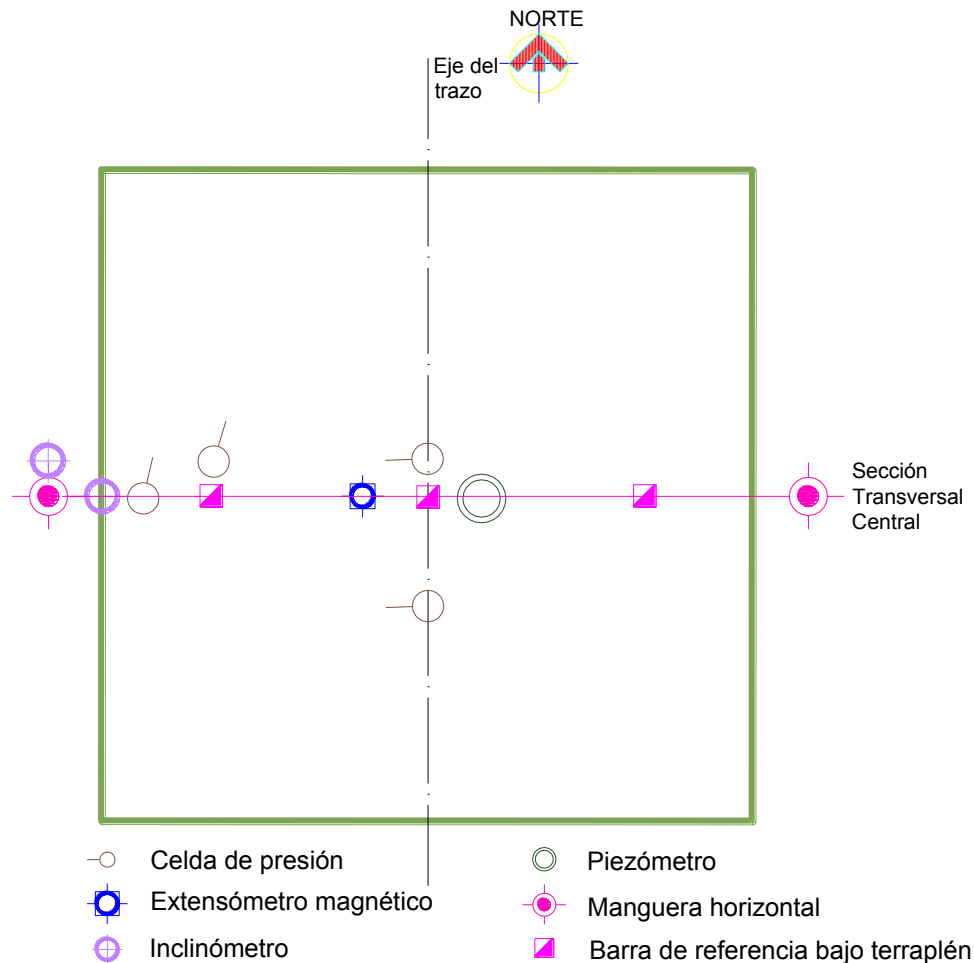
k.4 Esquema en planta de la Instrumentación para la sección compensada
